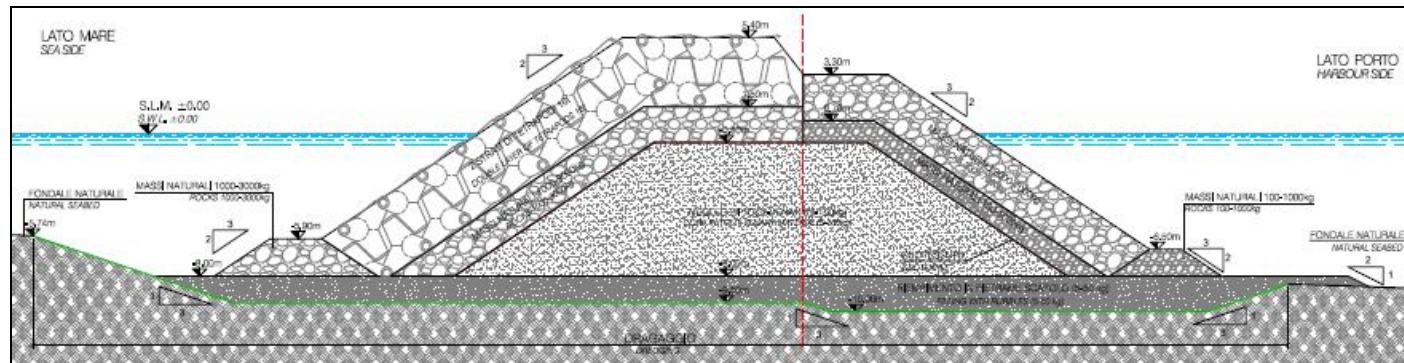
Seconda sezione di prova; sezione alla progressiva 250m
